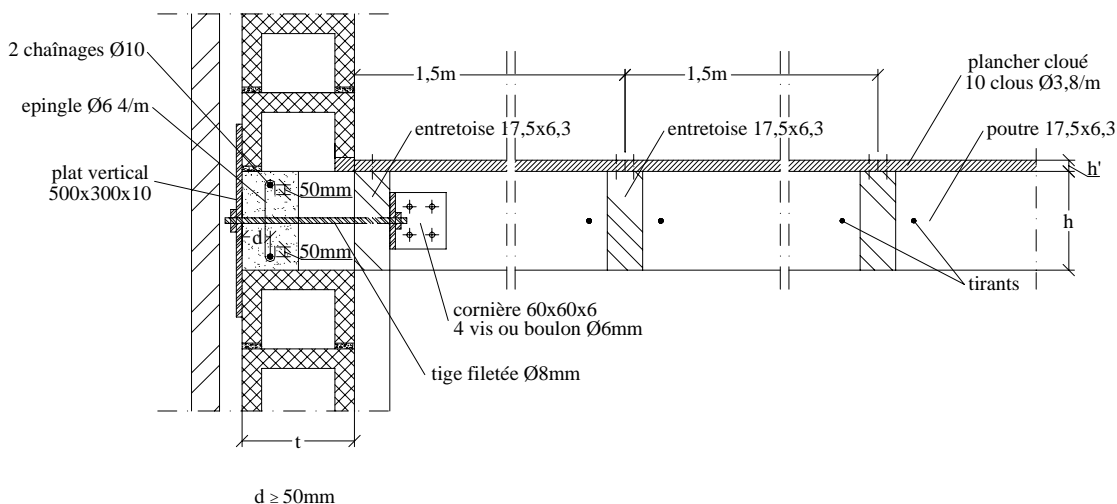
Liaison entre poutre de plancher en bois et mur avec plaque à l'arrière du mur.
